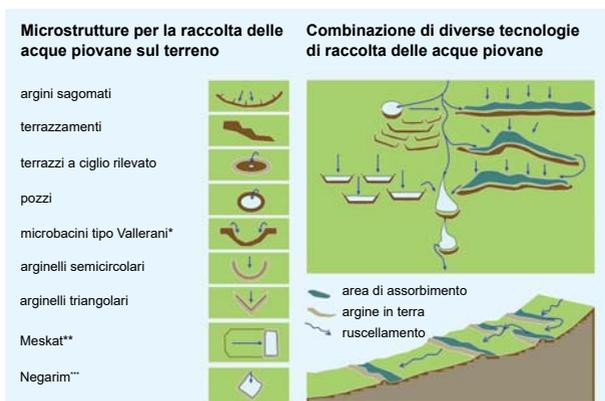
Schema delle tecniche per la protezione del suolo dall'erosione e per la raccolta e conservazione dell'acqua piovana sul terreno.
